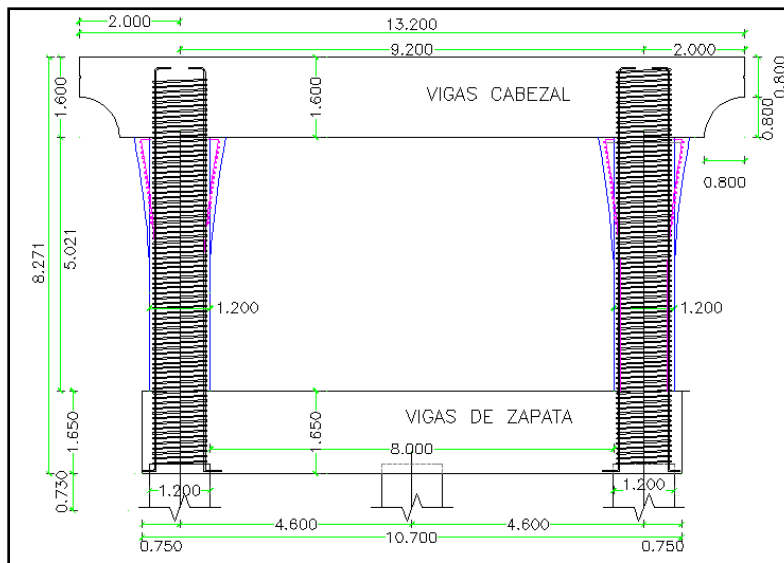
18: Corte transversal del puente – Vista en elevación de Pilas, Cabezal y Aisladores. (CEE, 2007)
